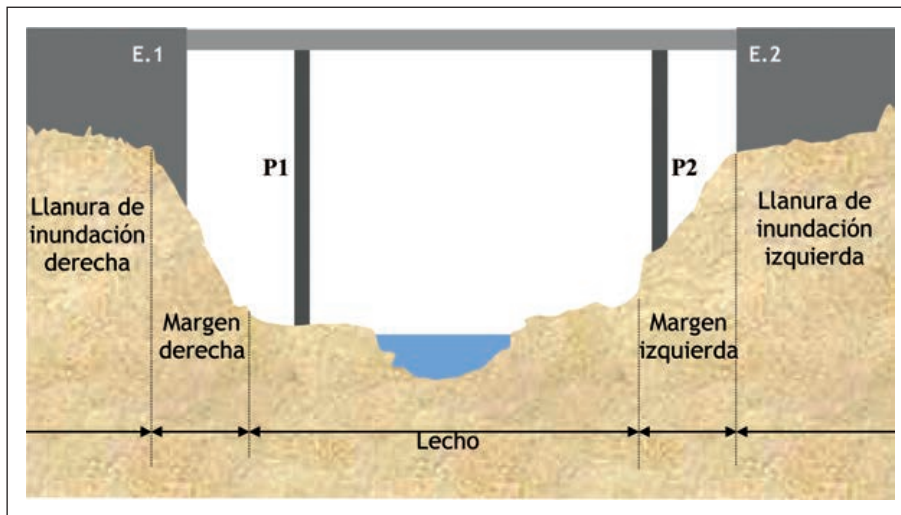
PILAS EN «LECHO» Y «MARGEN IZQUIERDA».
